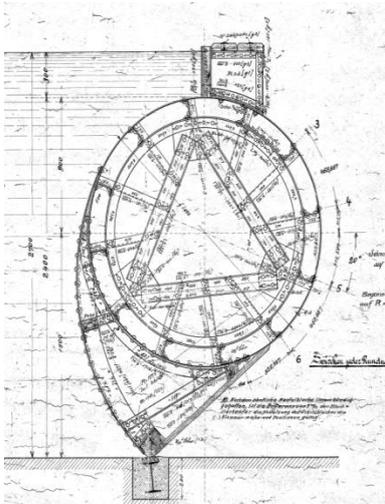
Schnitt durch Walzenkörper, Pläne von 1911 (Quelle: Bestandsplan, Tiefbauamt Augsburg)
